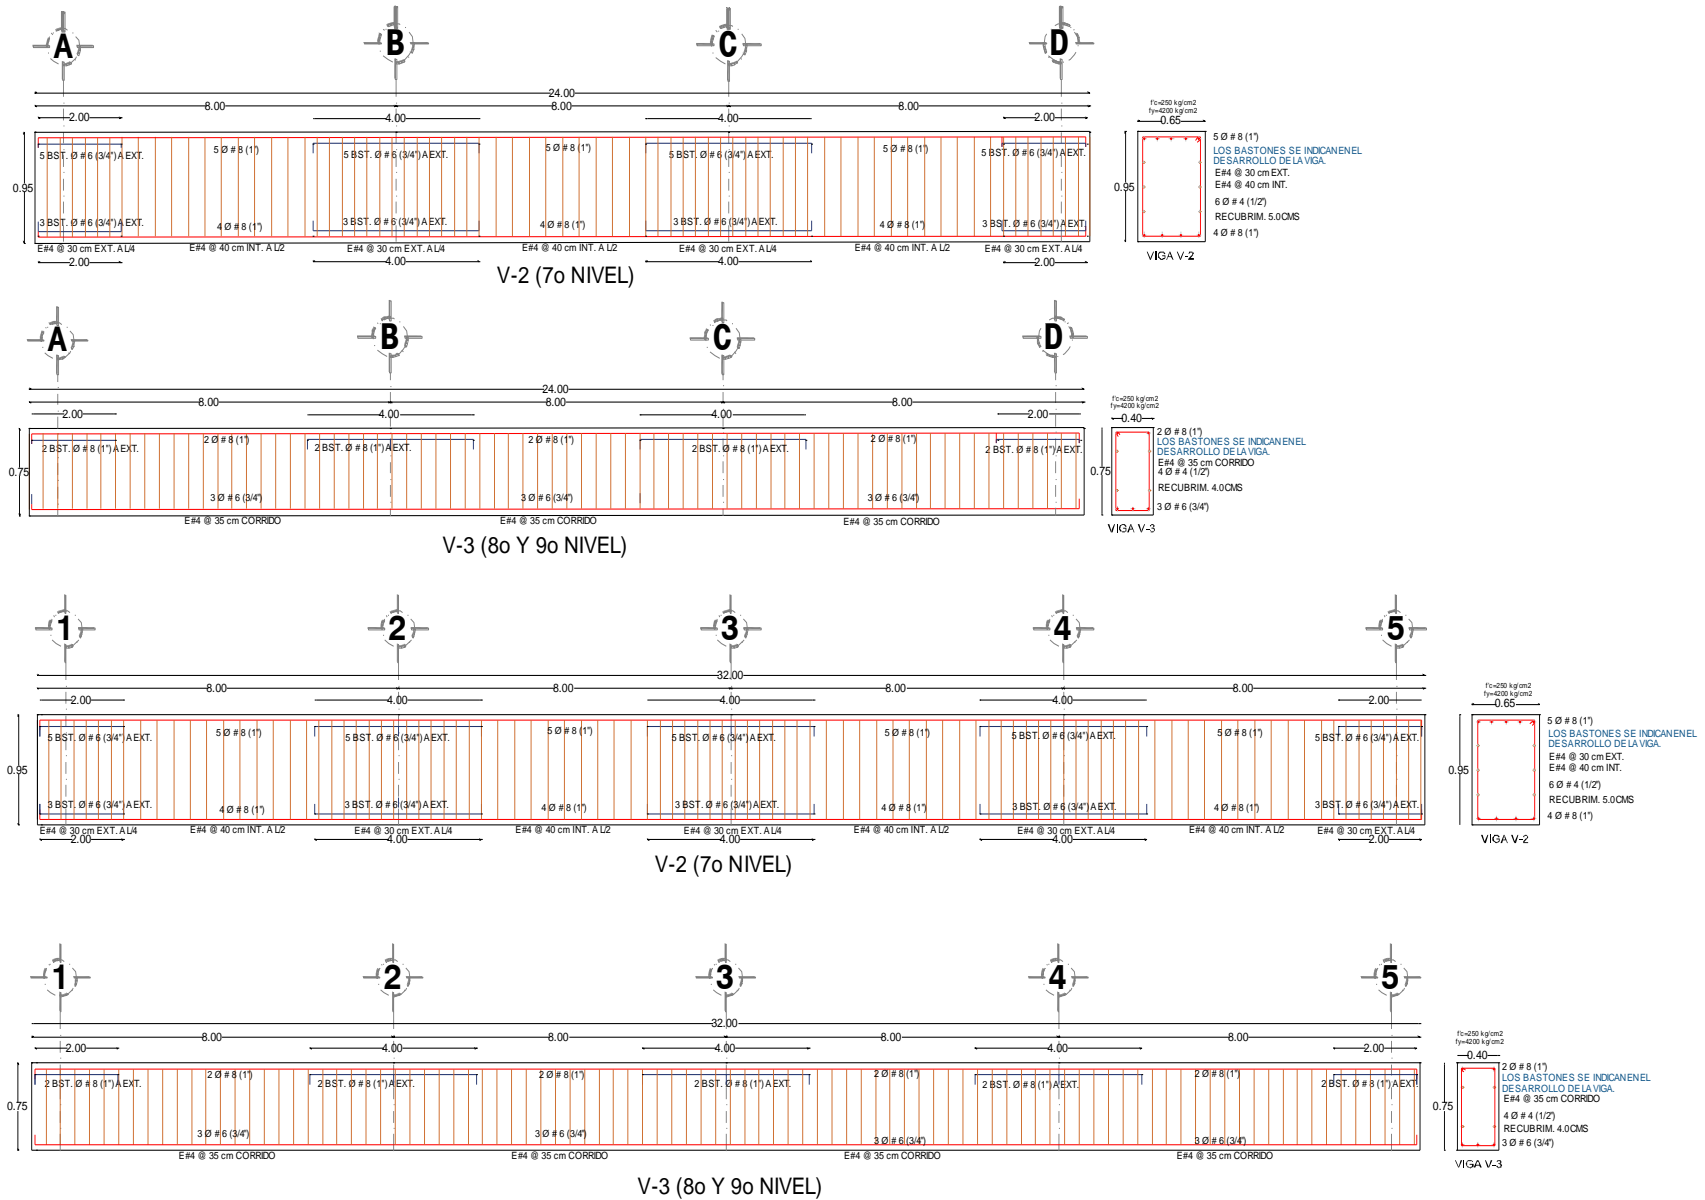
Detallado de armado de vigas de edificio de 9 niveles con base a la hipótesis de las NTCC-17.
